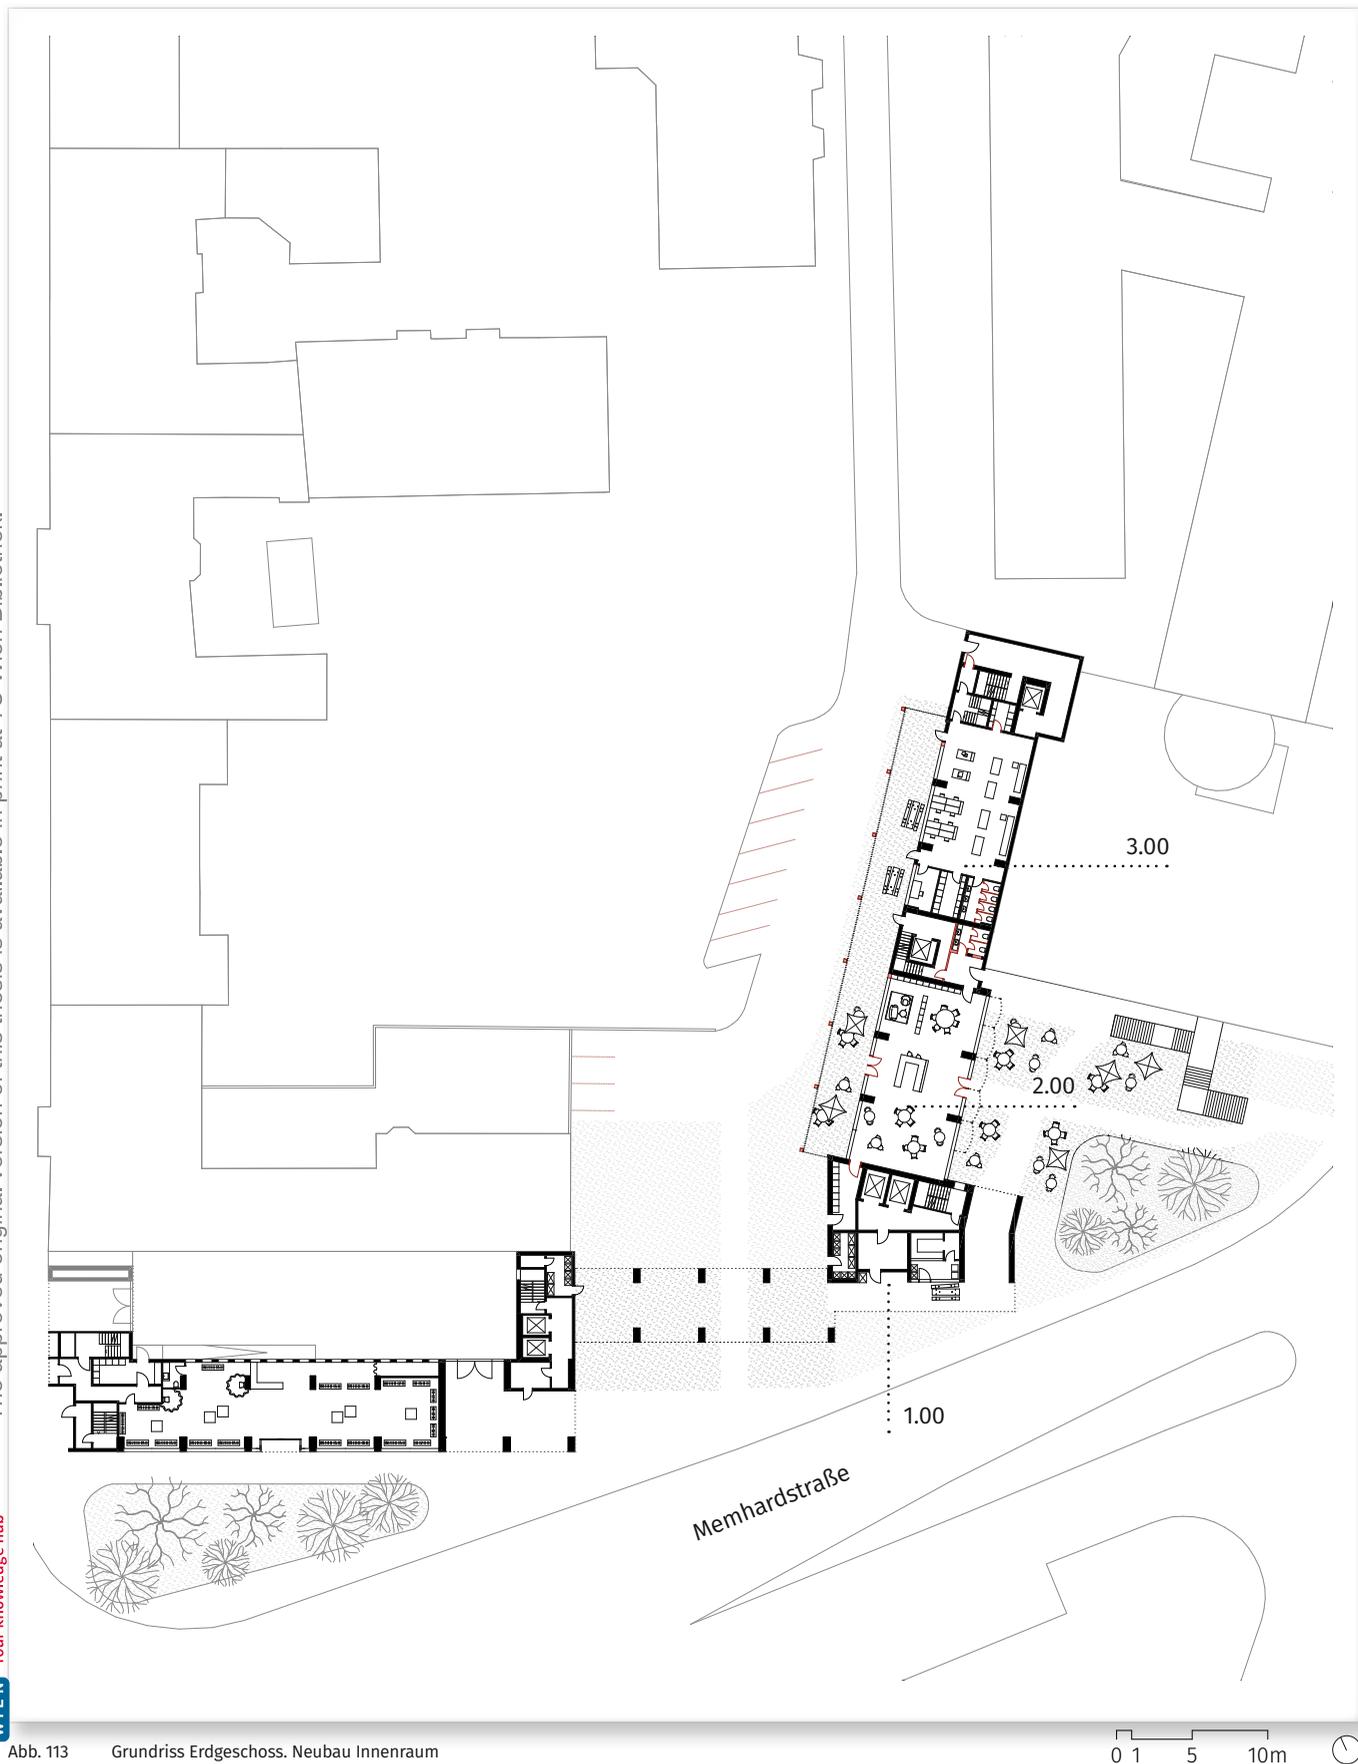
Grundriss Erdgeschoss. Neubau Innenraum
